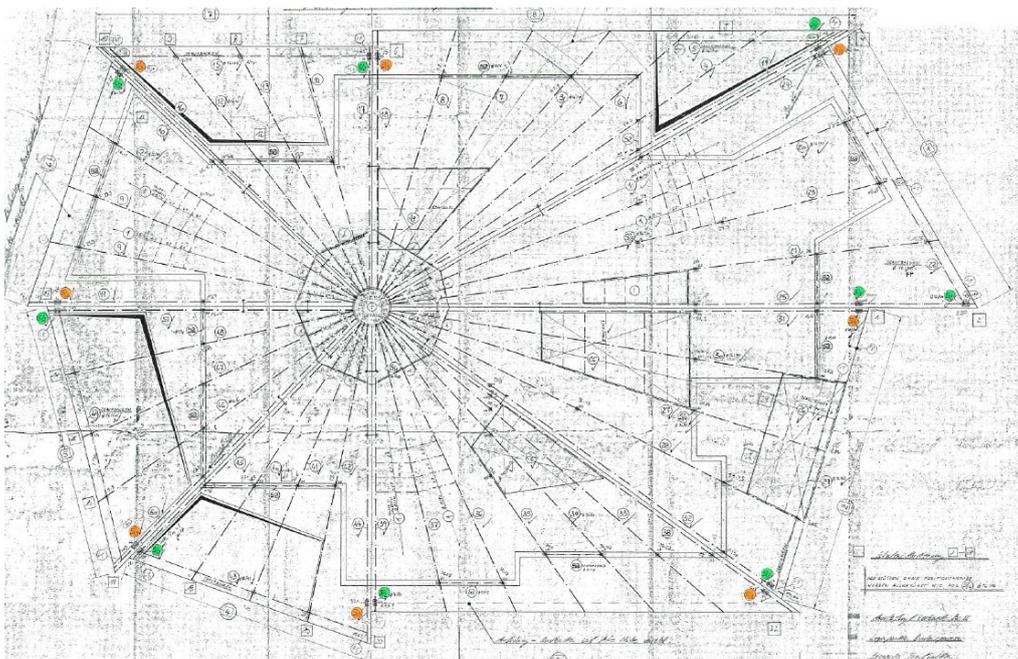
Grundriss Kita aus Positionsplan vom 30.07.1992
